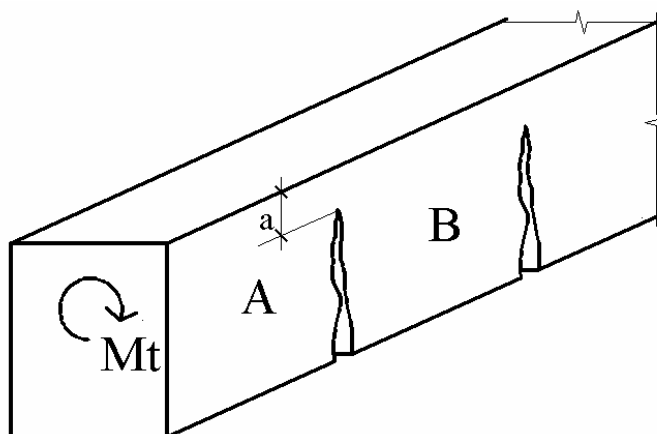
Схема железобетонного элемента с нормальными трещинами, нагруженного крутящим моментом
